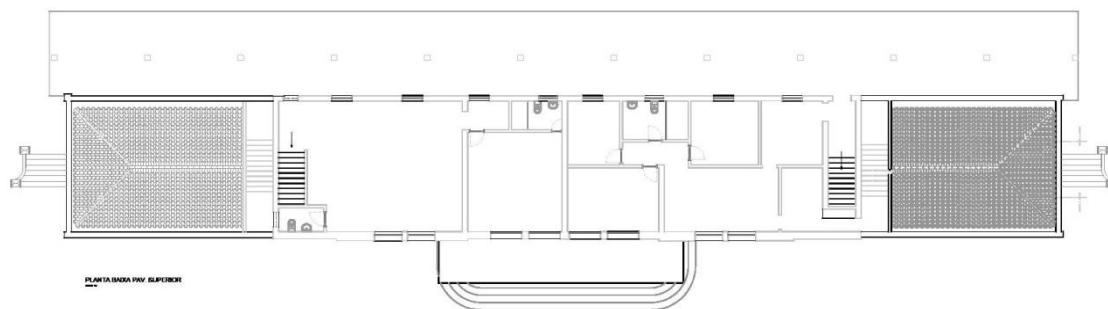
Planta Baixa da Estação - 1º Pavimento.
